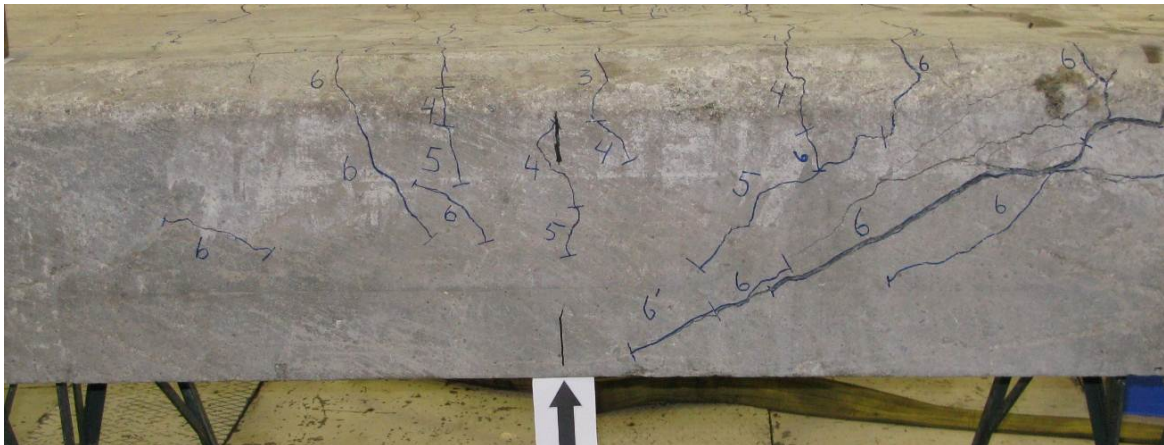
Element 4A, foto etter belastning til 660 kN
